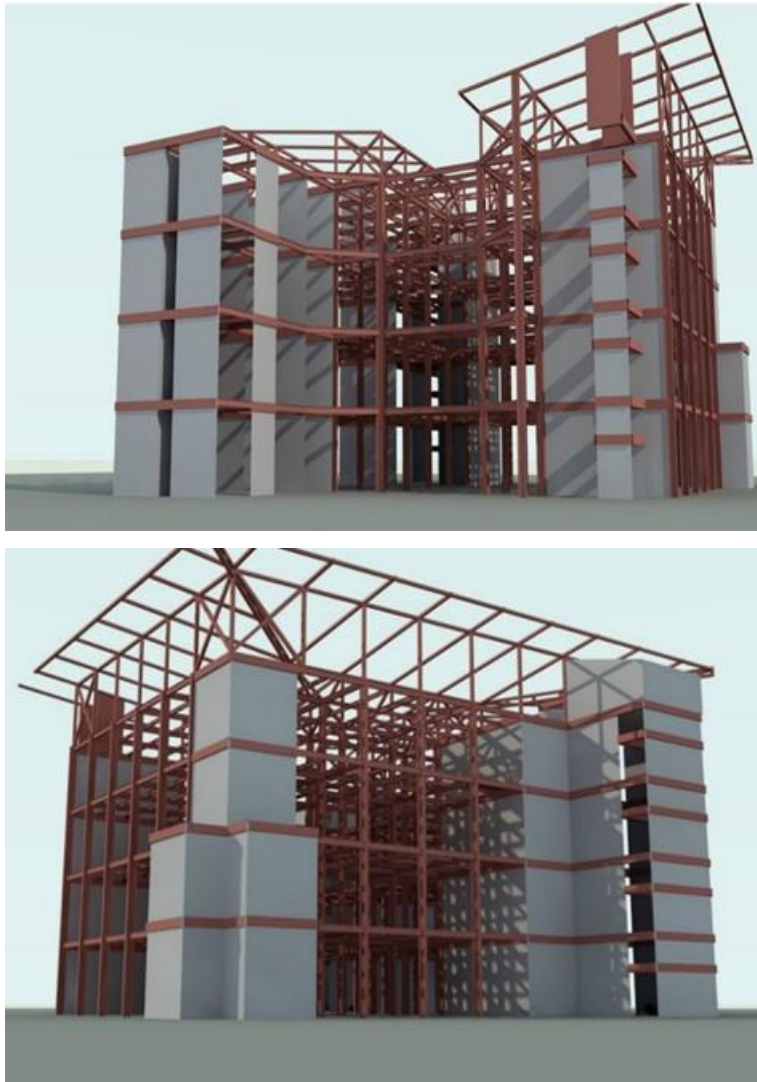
Sistema de muros de concreto y perfiles metálicos en Edificio de Tecnologías en Salud de la UCR. (OEPI, 2017)
